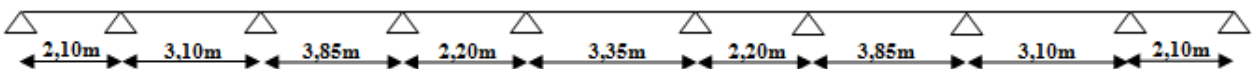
Les types des poutrelles de plancher étage courant.
